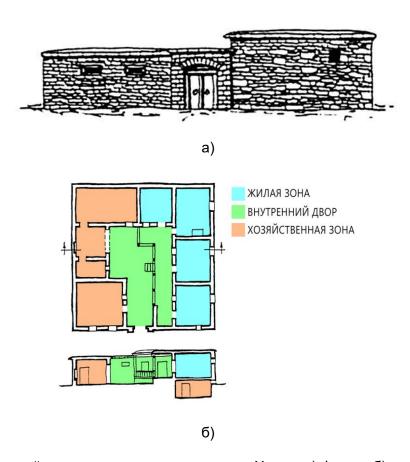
Одноэтажный дом с внутренним двором в с. Хурхи: а) фасад; б) план и разрез
